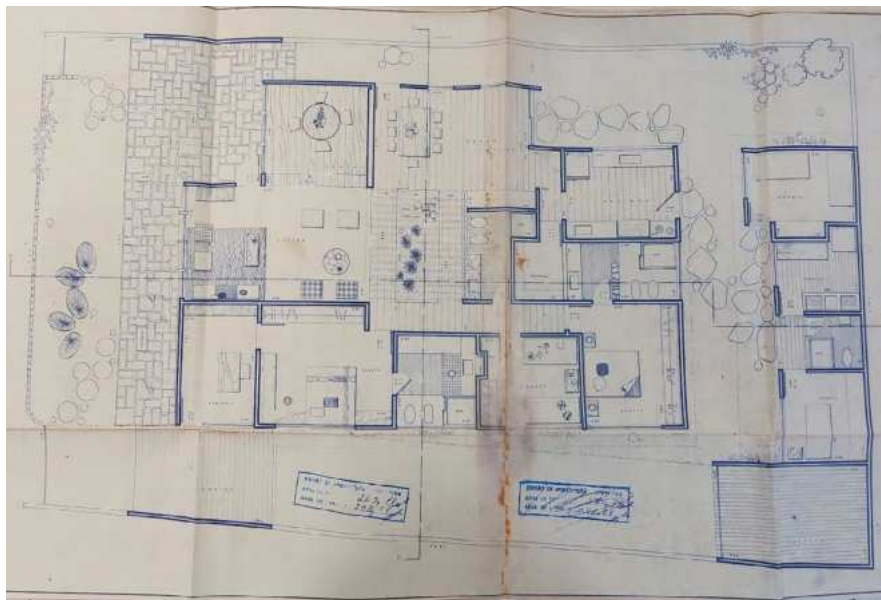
Residência Eleusa Passos Tenório - Planta Baixa. Fonte: Levantamento de Ramalho (2023).
